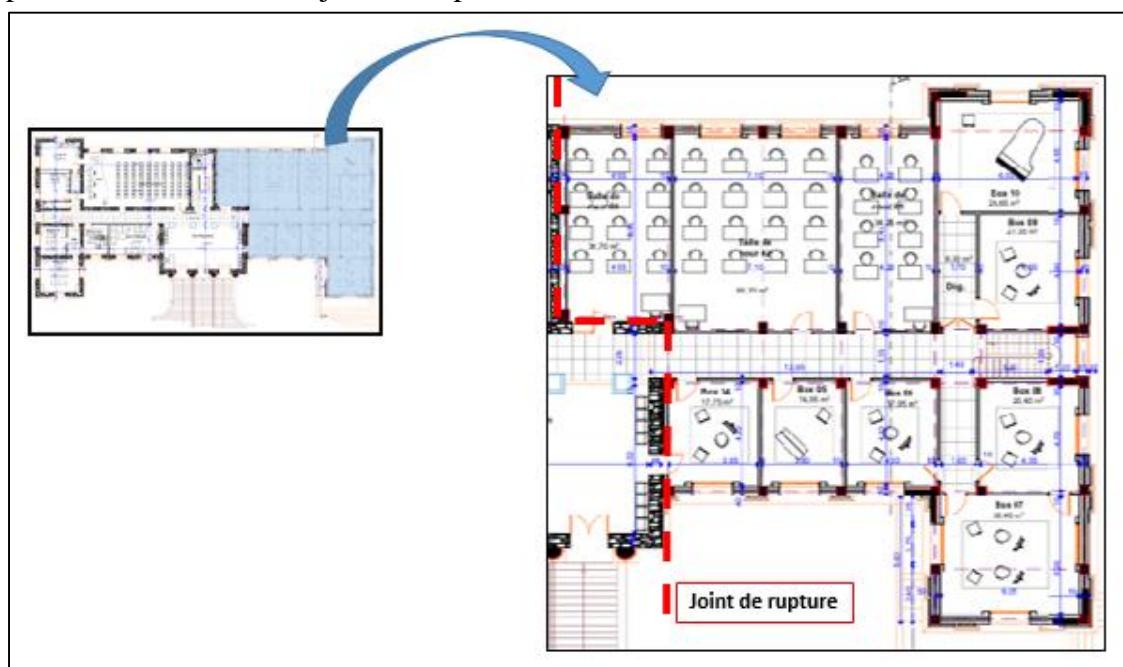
La partie qui a été réhabilité après effondrement (Fond : plan de bureau d'étude Ben Sahnoun. Traitement : auteur 2025.).
